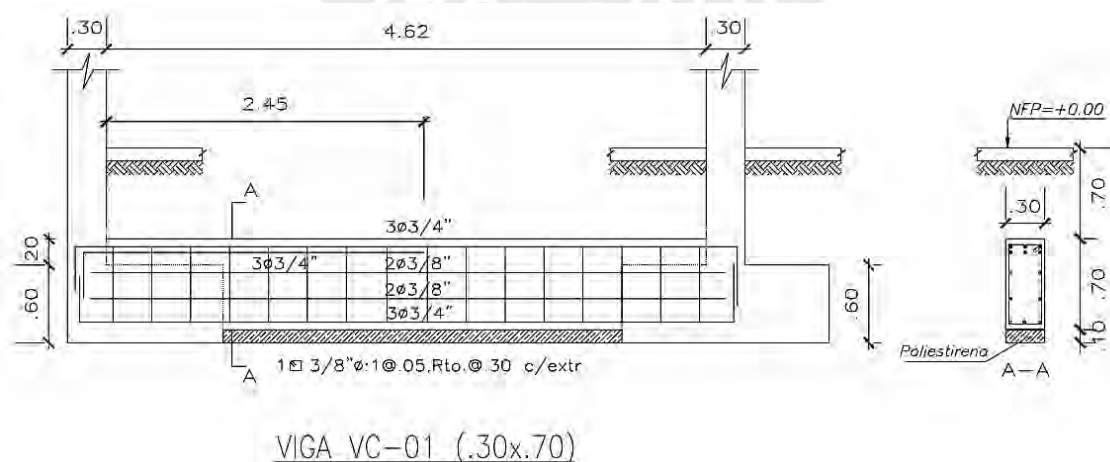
Detalle de armado de la viga de cimentación de sistema dual
